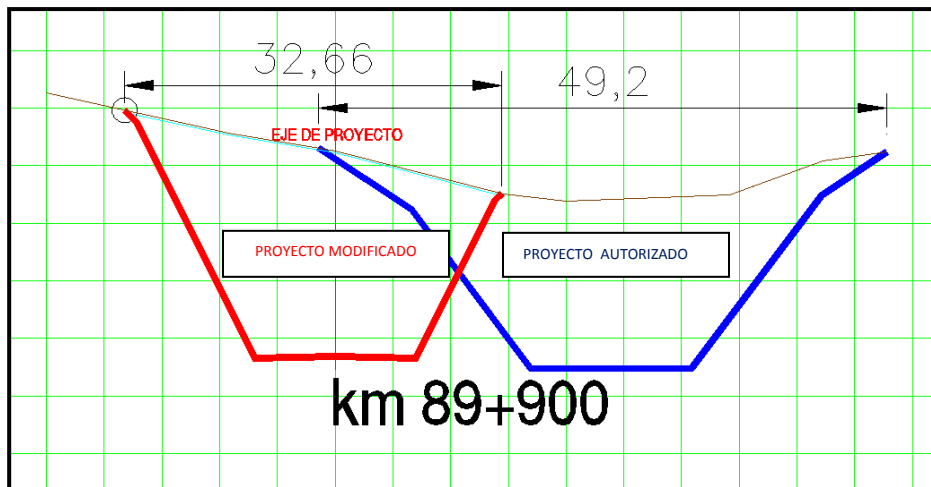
Mejora de sección proyecto autorizado - sección proyecto modificado.
